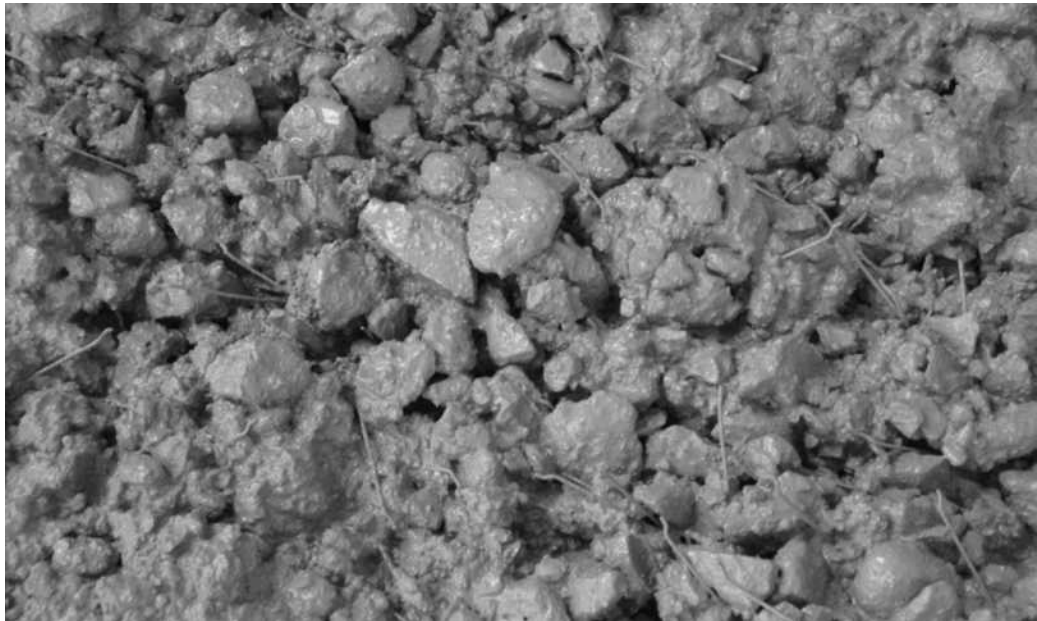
Fibrat metalike strukturore të përziera në brumin e betonit
